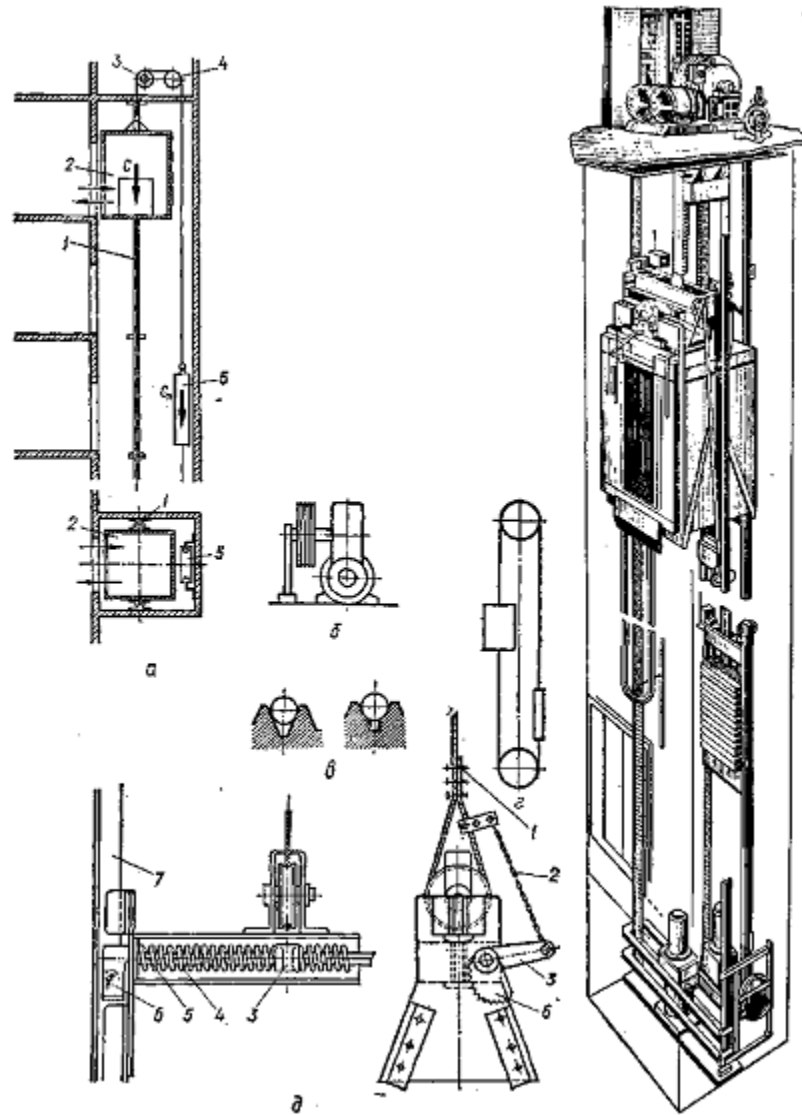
Лифт пассажирский. Загальний вигляд
